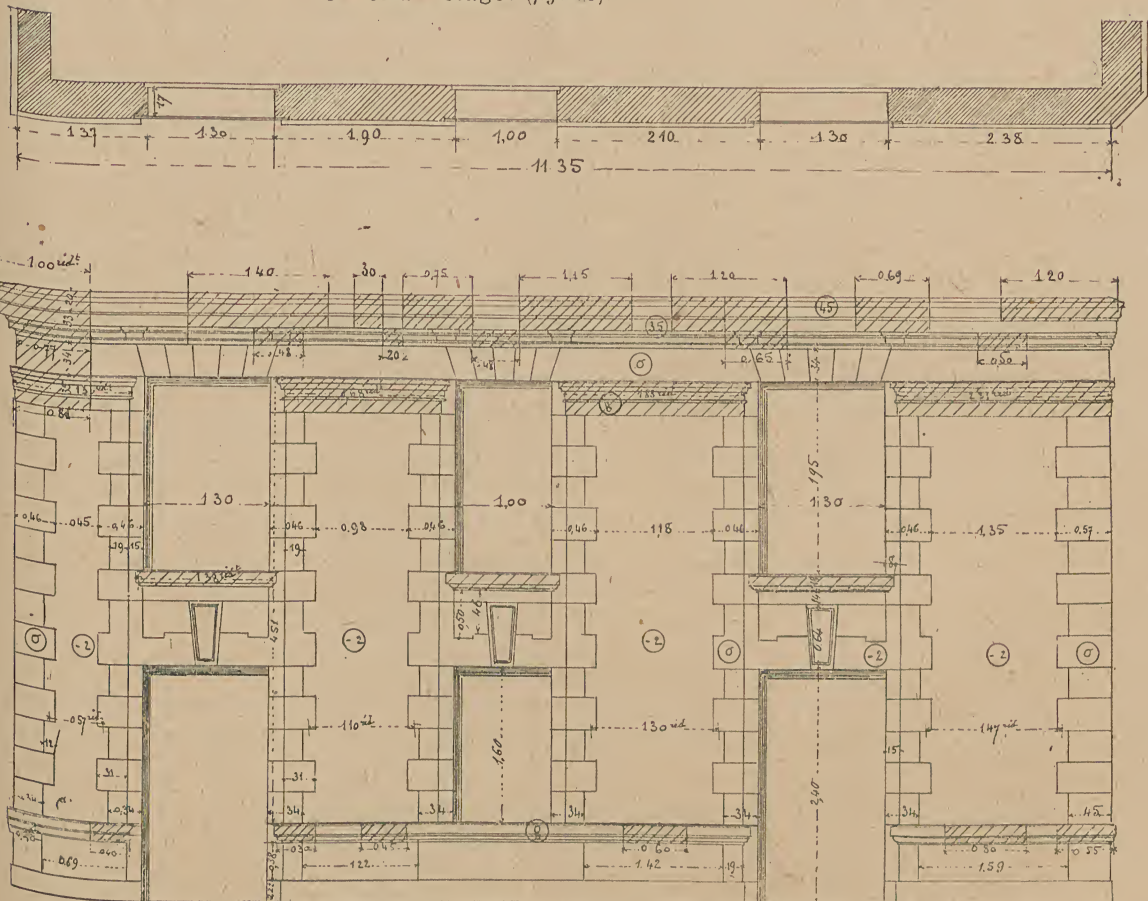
Ravalement en plâtre sur vieux mur 3^e et 4^e étages sur cour.
